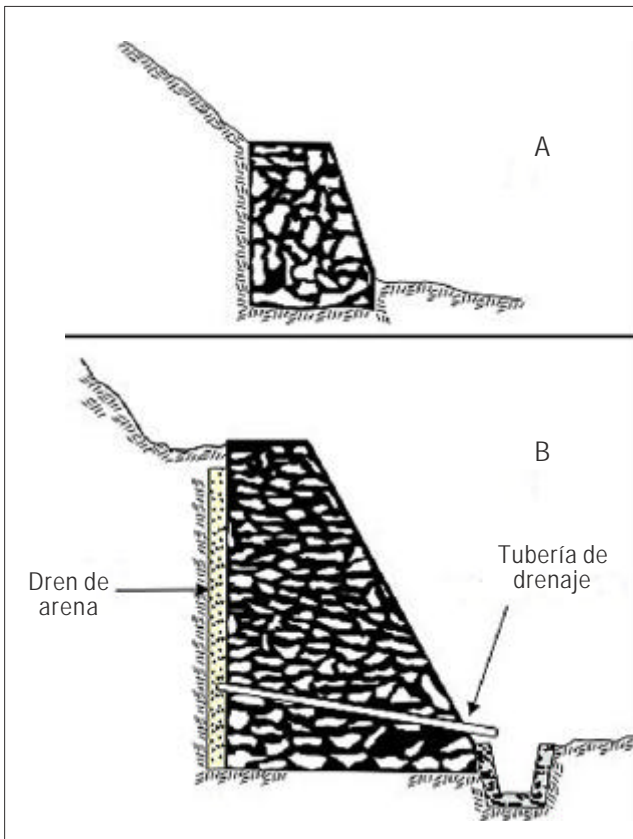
Muros de gravedad: A) de piedra seca, B) de piedra argamassada.
